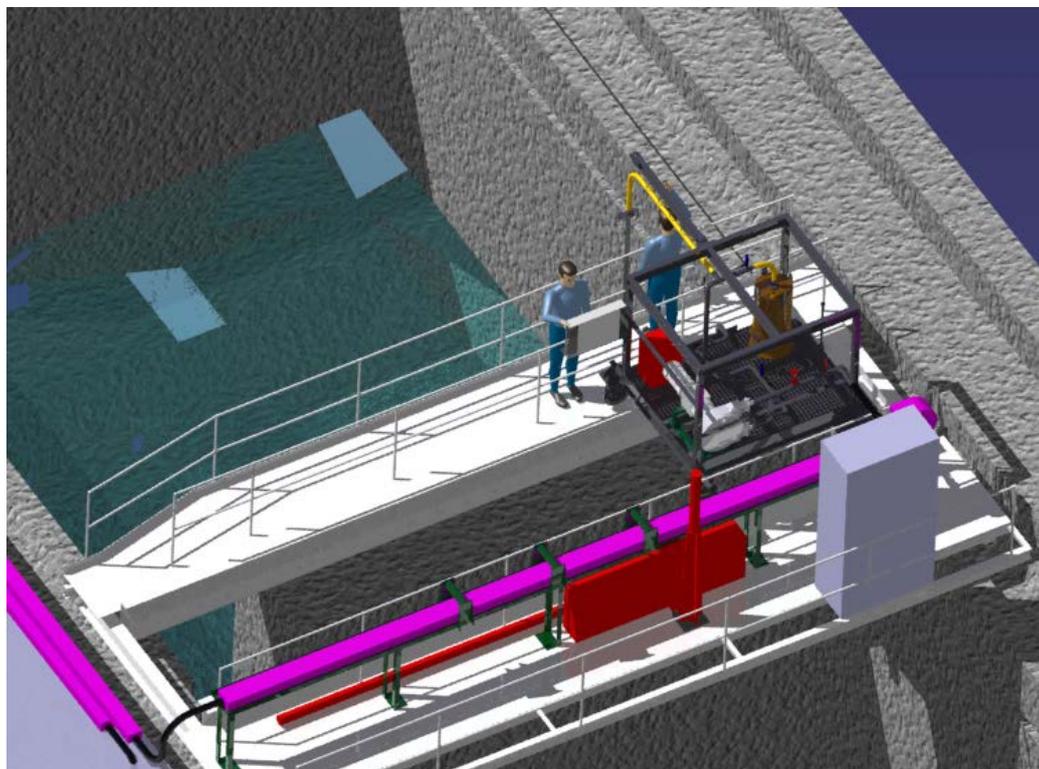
Edificio Pond: disposizione delle apparecchiature dello Skid sulla Gru Cesti.
